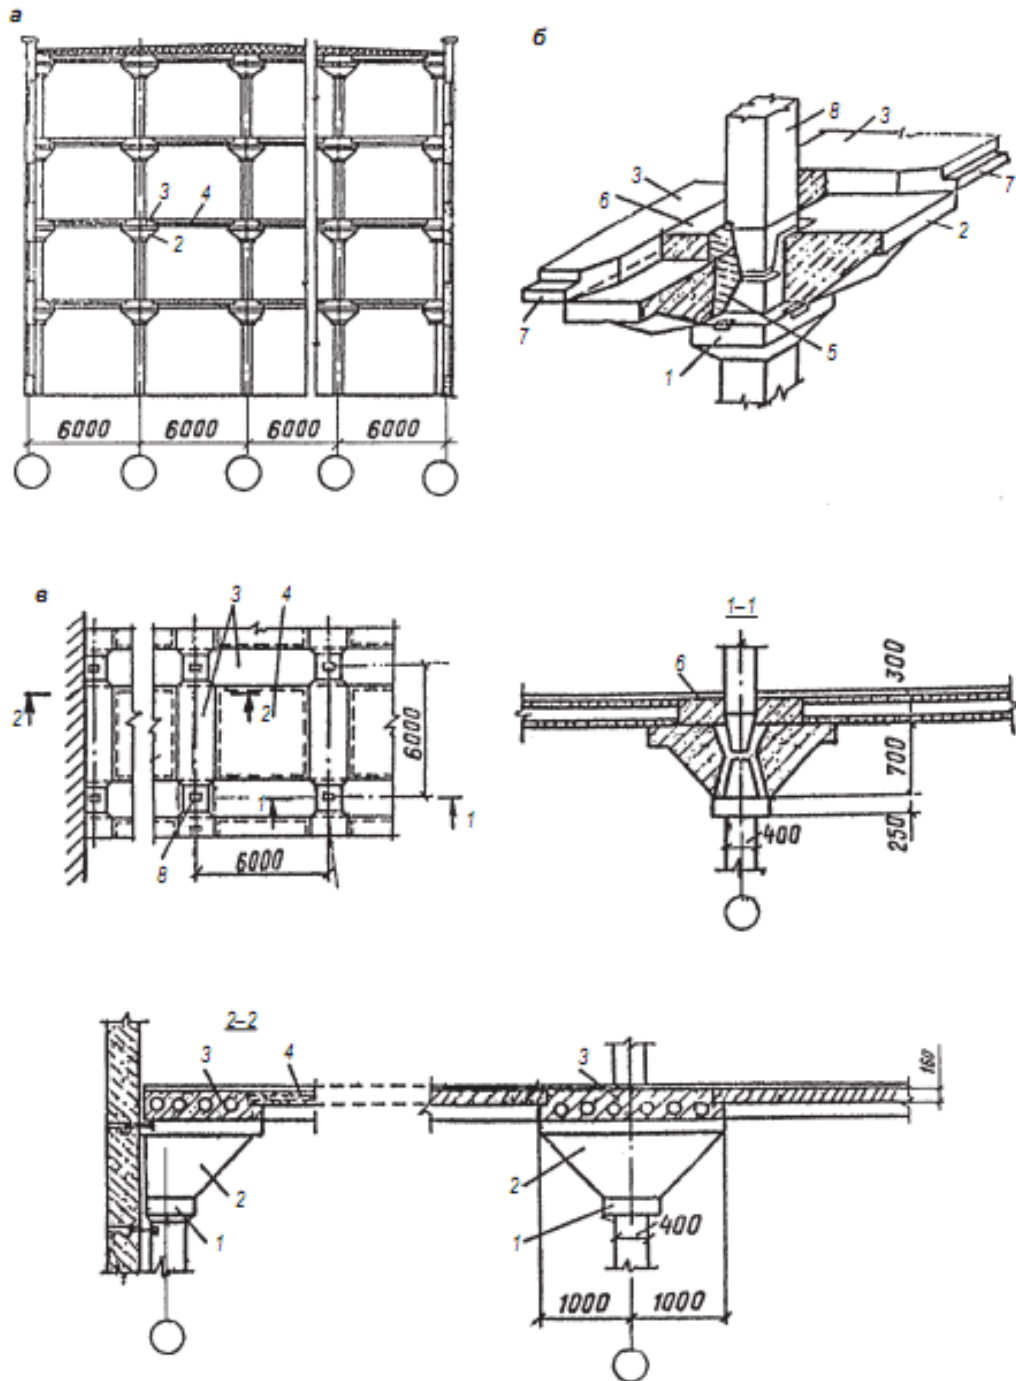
Збірні безбалкові перекриття: а – розріз; б – загальний вигляд; в – план; 1 – оголовок колони; 2 – капітель; 3 – панель міжколонна; 4 – панель пролітна; 5 – монолітний бетон; 6 – монолітний залізобетон; 7 – поличка для спирання пролітної плити; 8 – колона
